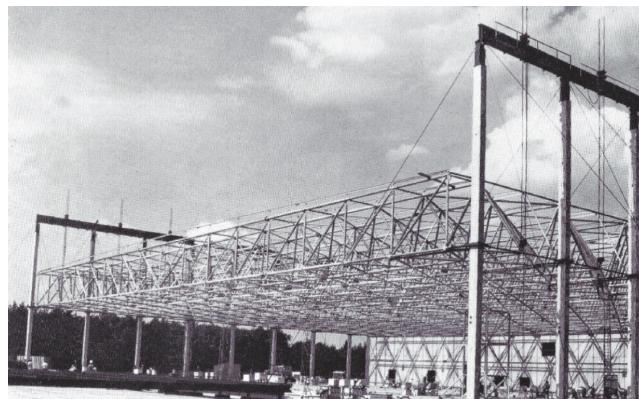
Podizanje gotove konstrukcije dizalicom [8]
